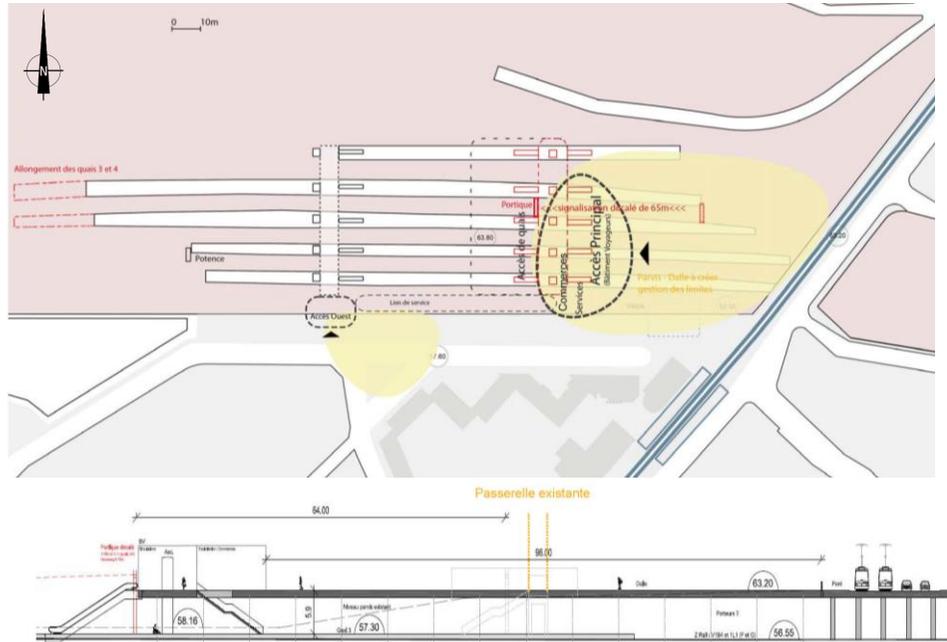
Schéma et coupe de principe d'un bâtiment pont (source : Egis + Arep)
